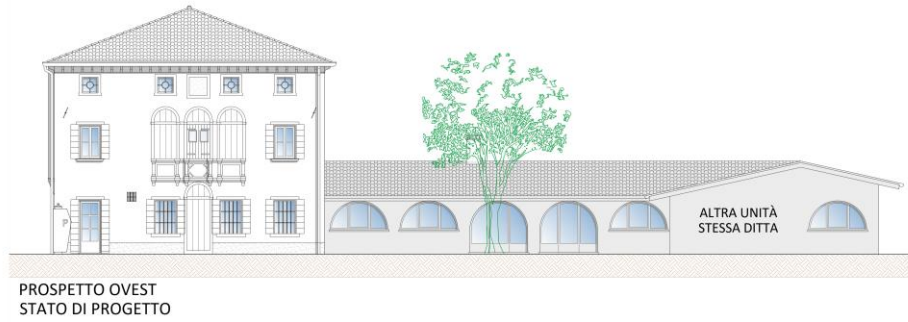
Prospetto Ovest - Stato di progetto - scala generica
